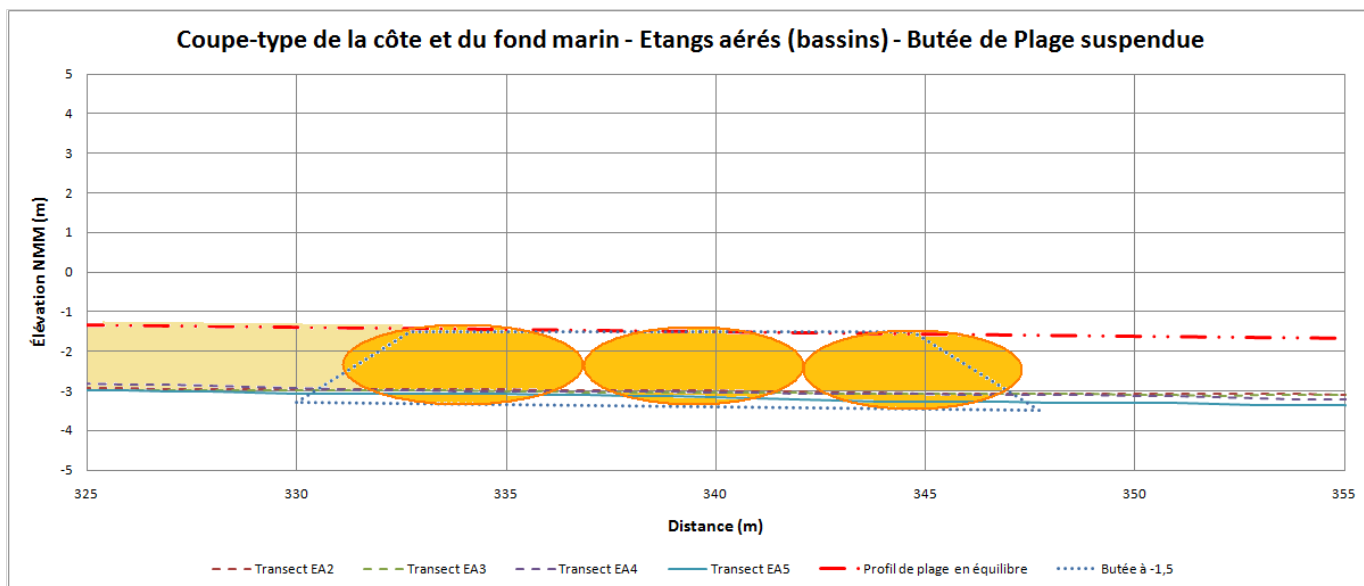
Coupe type d'une butée de pied de plage suspendue en géotubes à -1,5 m NMM
